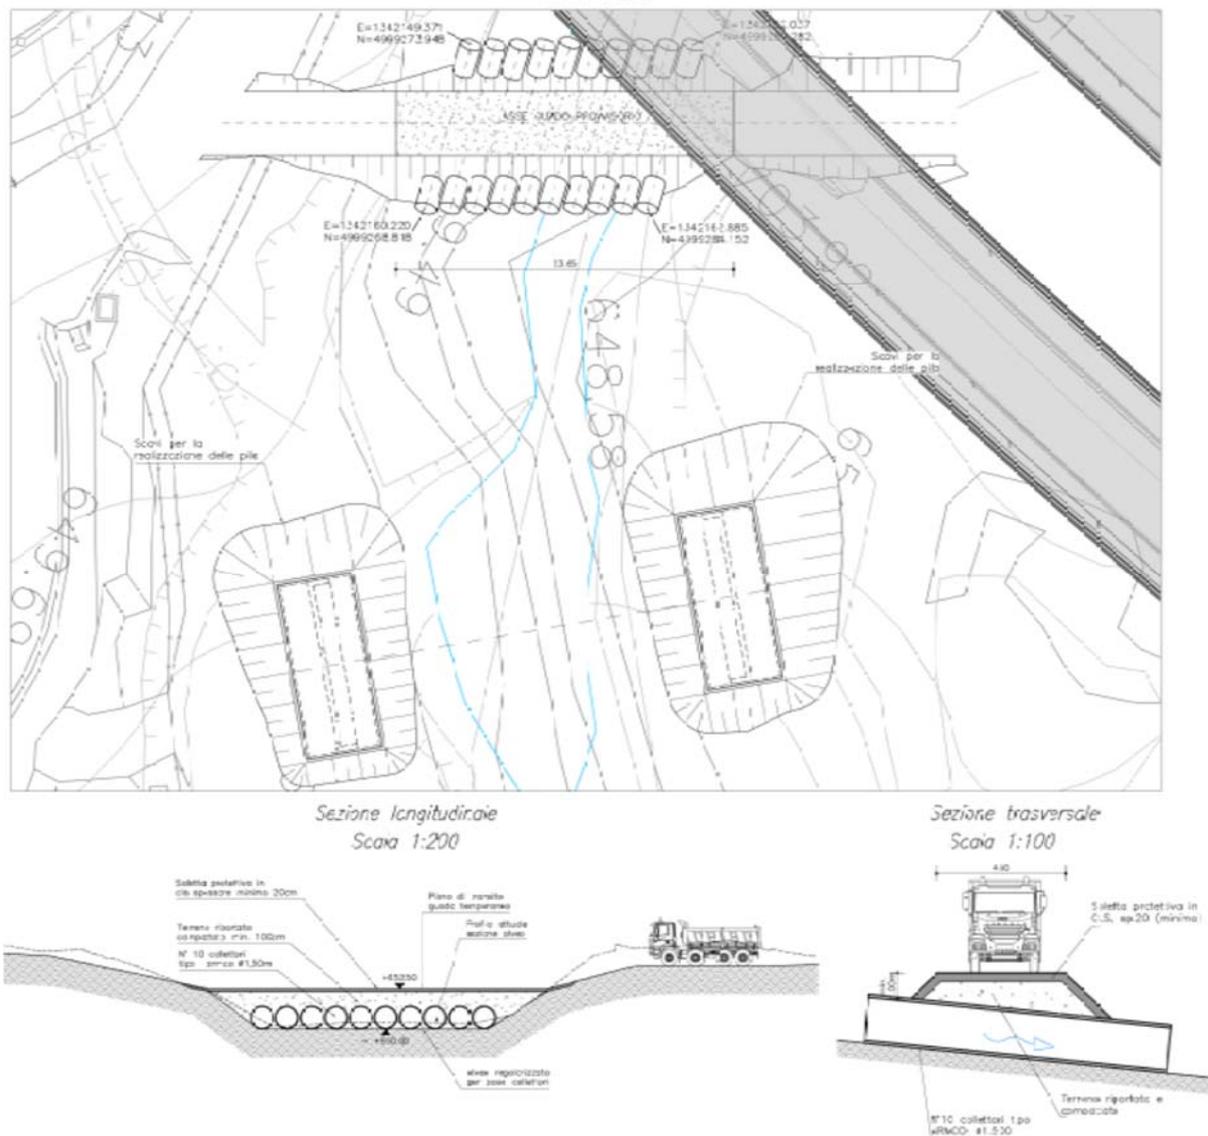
Vista d'insieme Guado di attraversamento Rio Clarea
